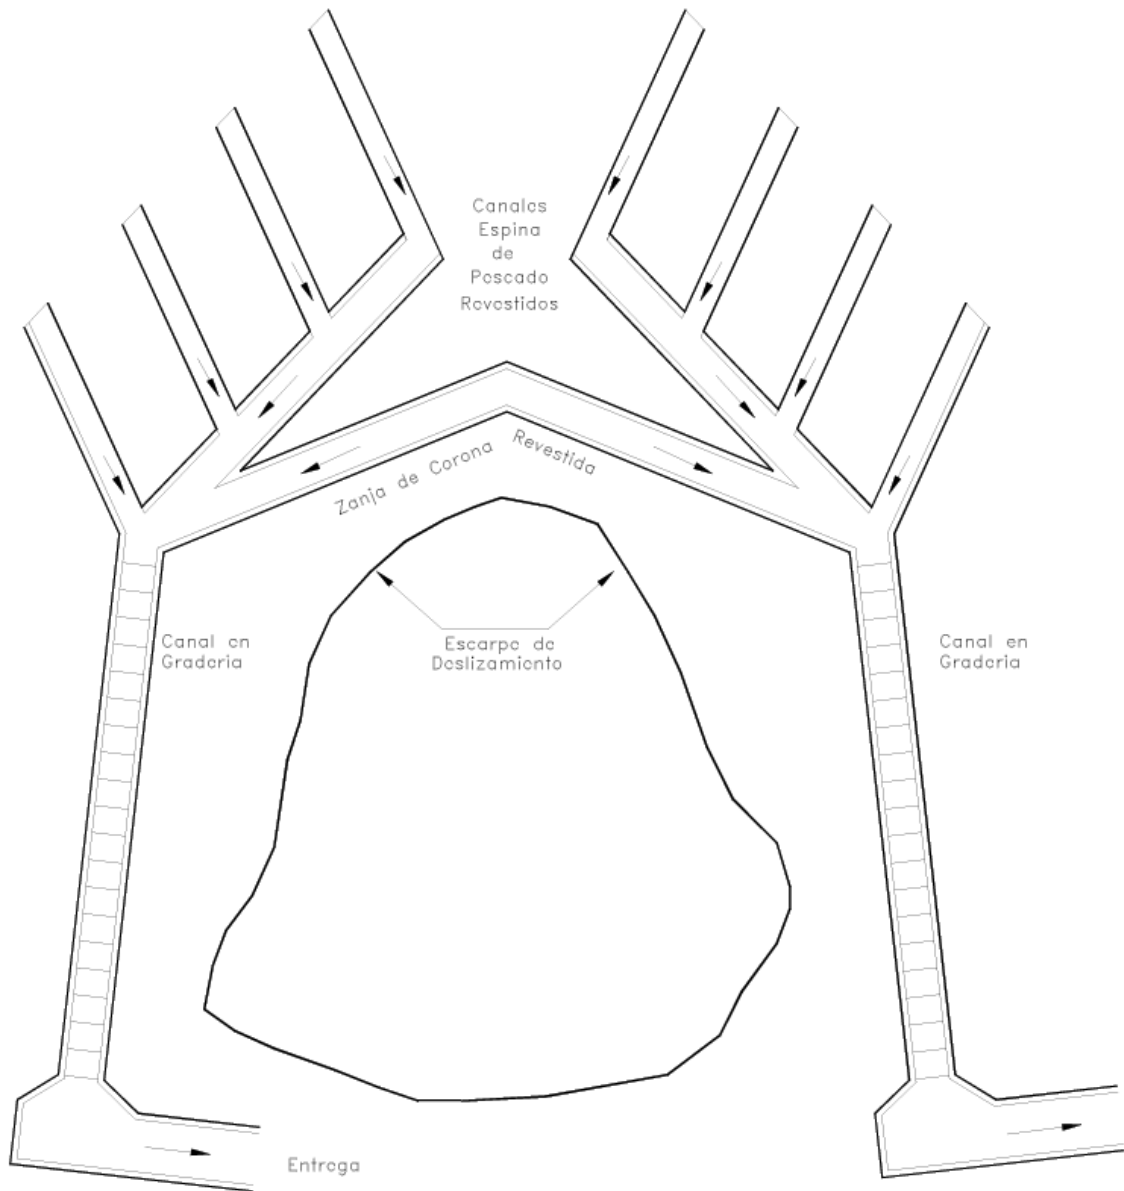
Esquema en planta de canales colectores espina de pescado. (Tomado de Suárez, 1998).
